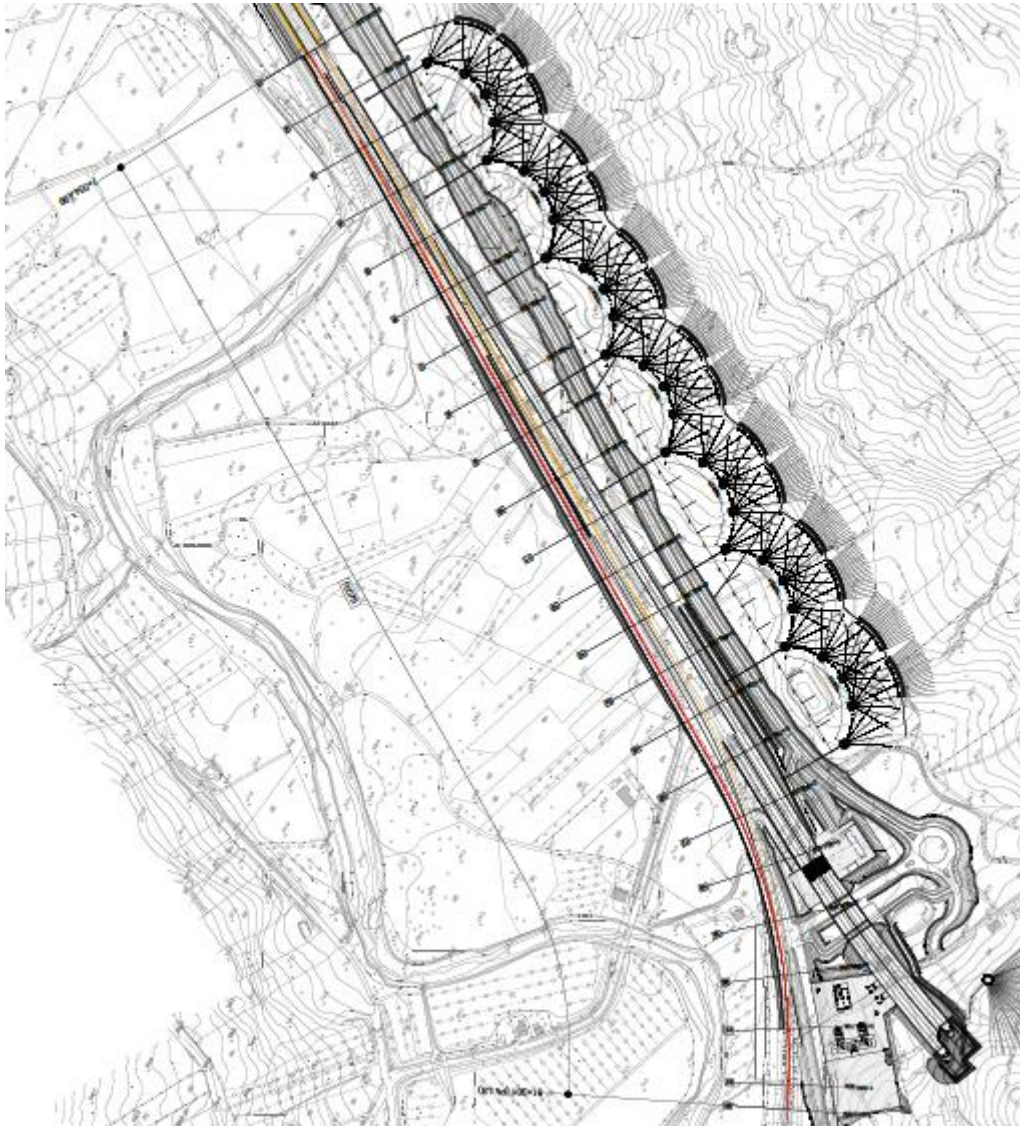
Stralcio planimetrico Variante Provvisoria Bretella Dispari
